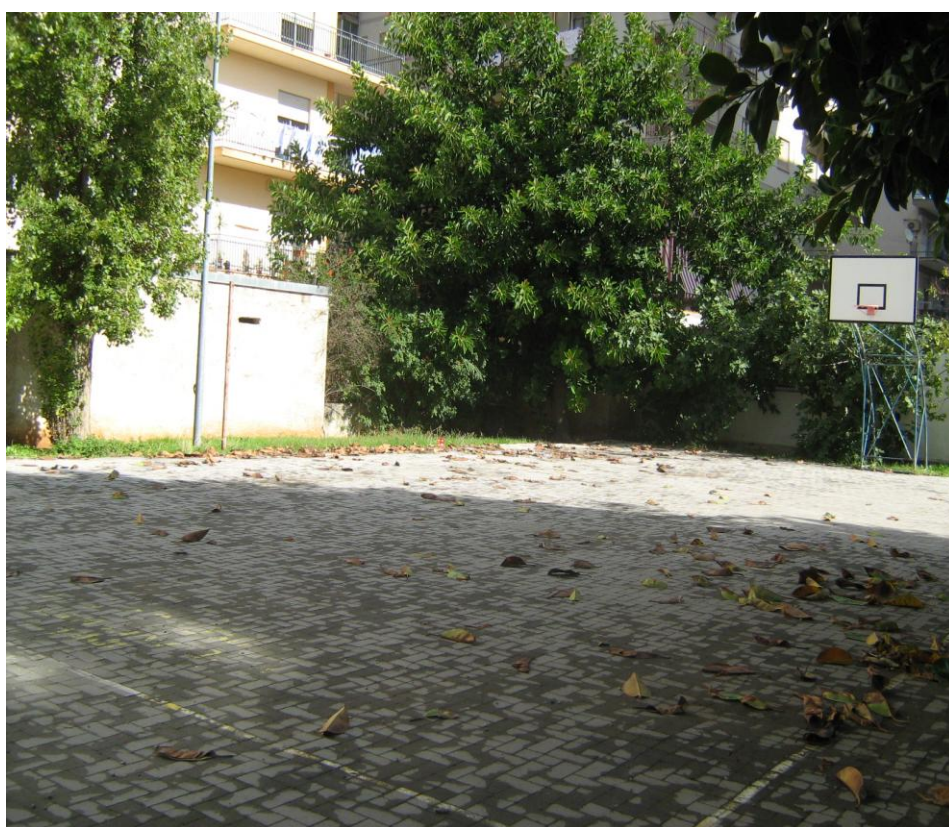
Il campetto per la pallacanestro da ripristinare.
